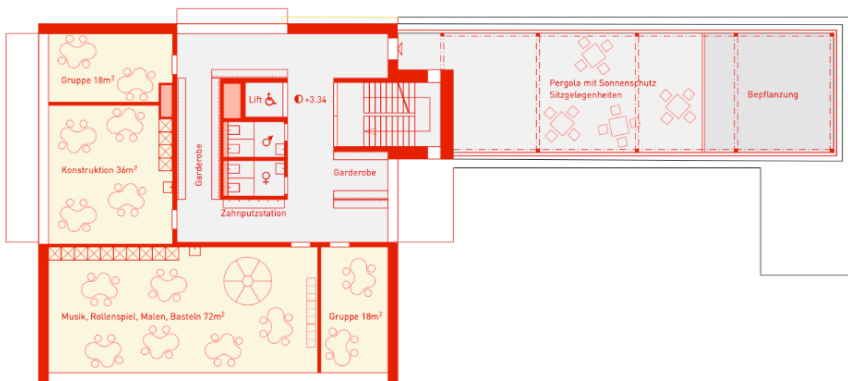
Grundriss des 1. Obergeschosses.
